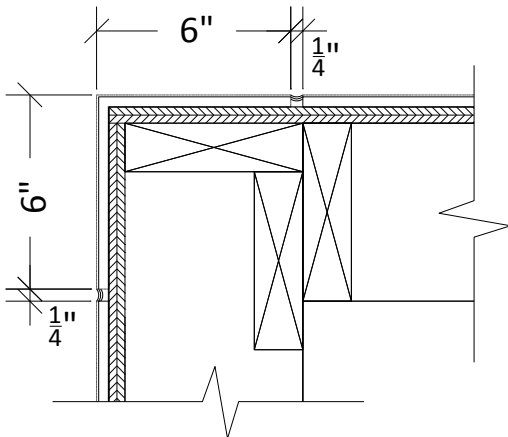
Esquina Exterior (Pre-Fabricada)
